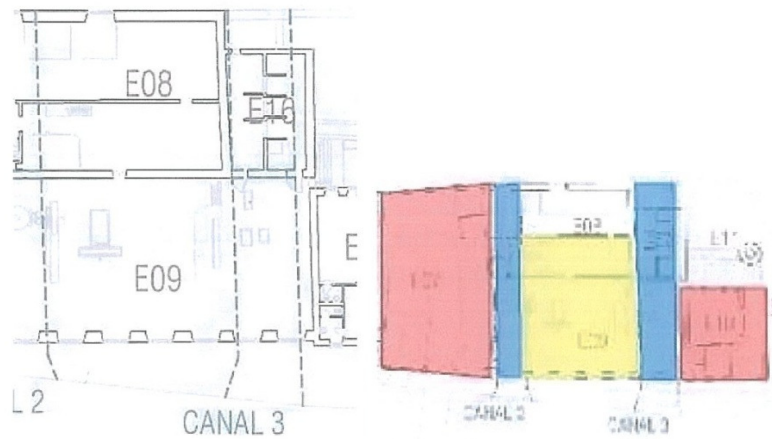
Comparação da planta actual e a planta quinhentista (CCG Arquitectos Lda.).
